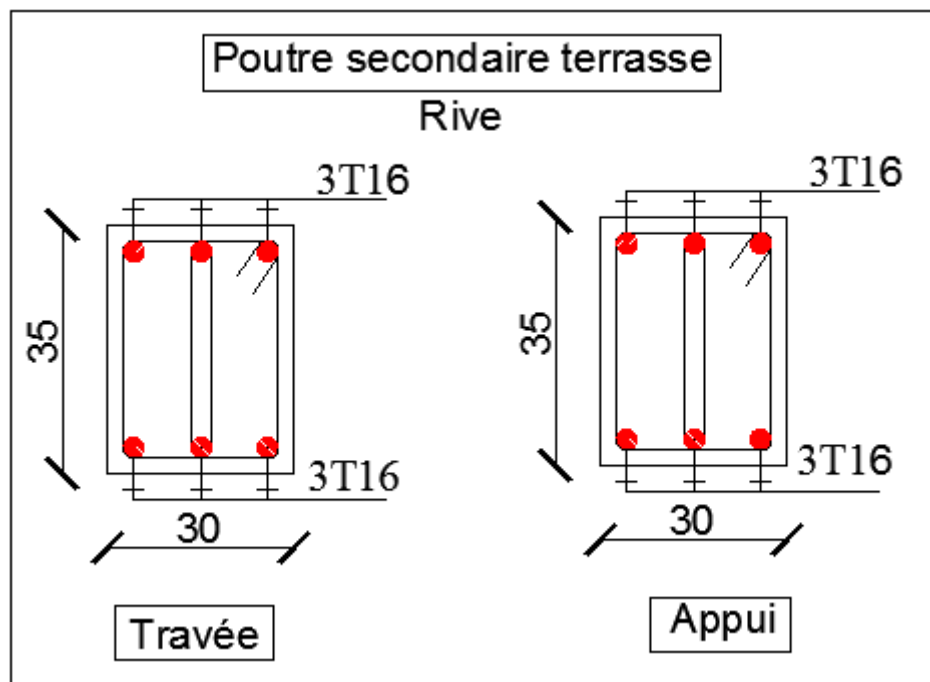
Ferrailage des poutres secondaires de rive du niveau terrasse.
